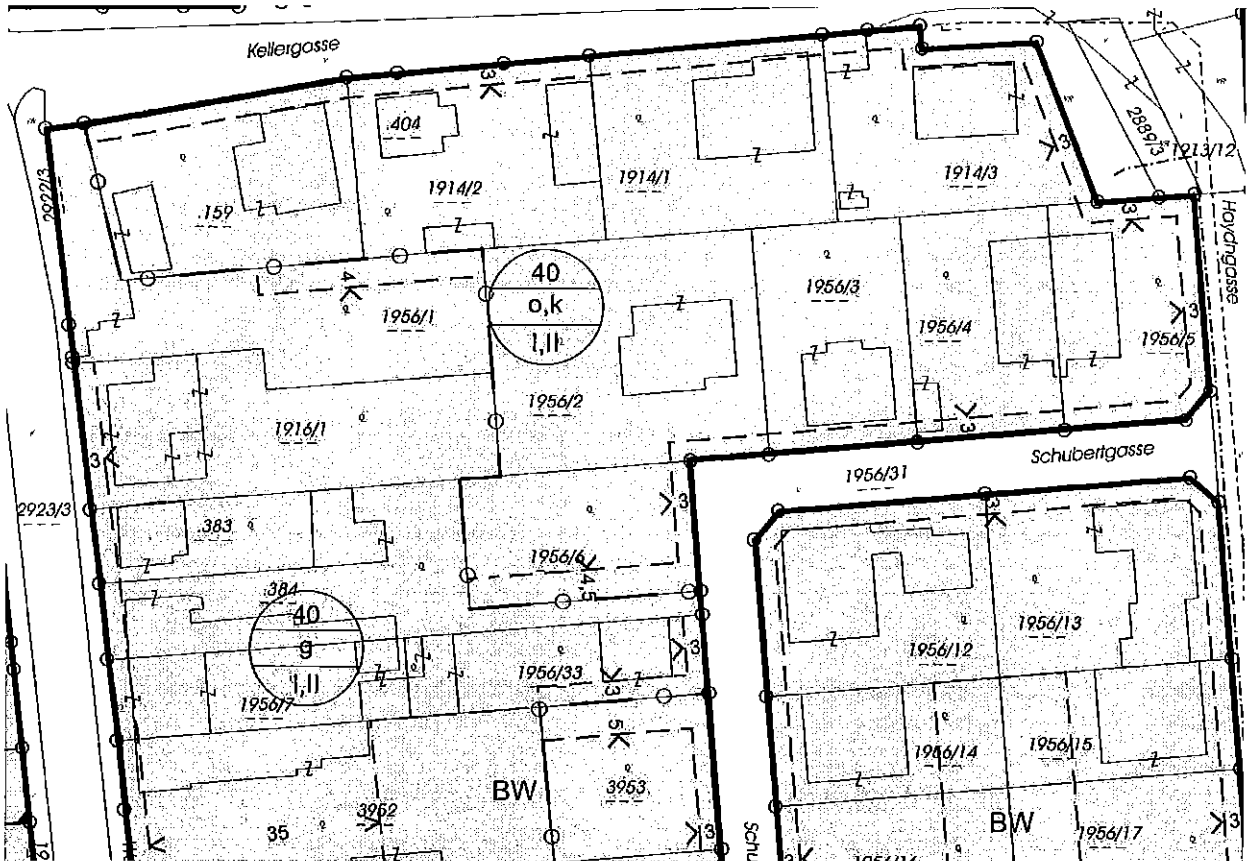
Auszug Beschluss; LAP ZT GmbH
